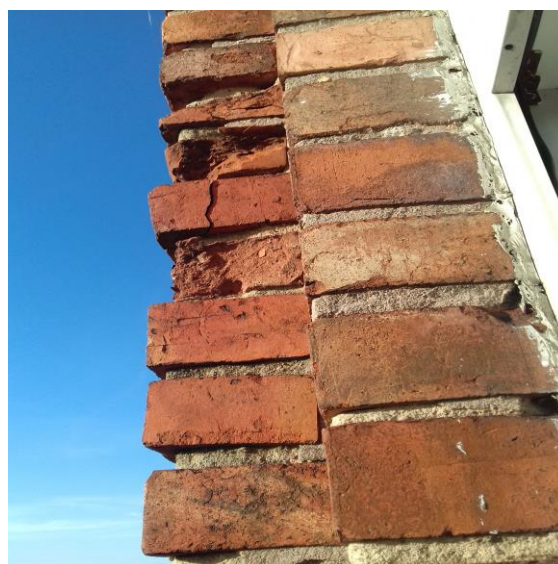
Elewacja szczytowa : widoczne zniszczenie cegły licowej, gzyms wzmocniony tynkiem.
